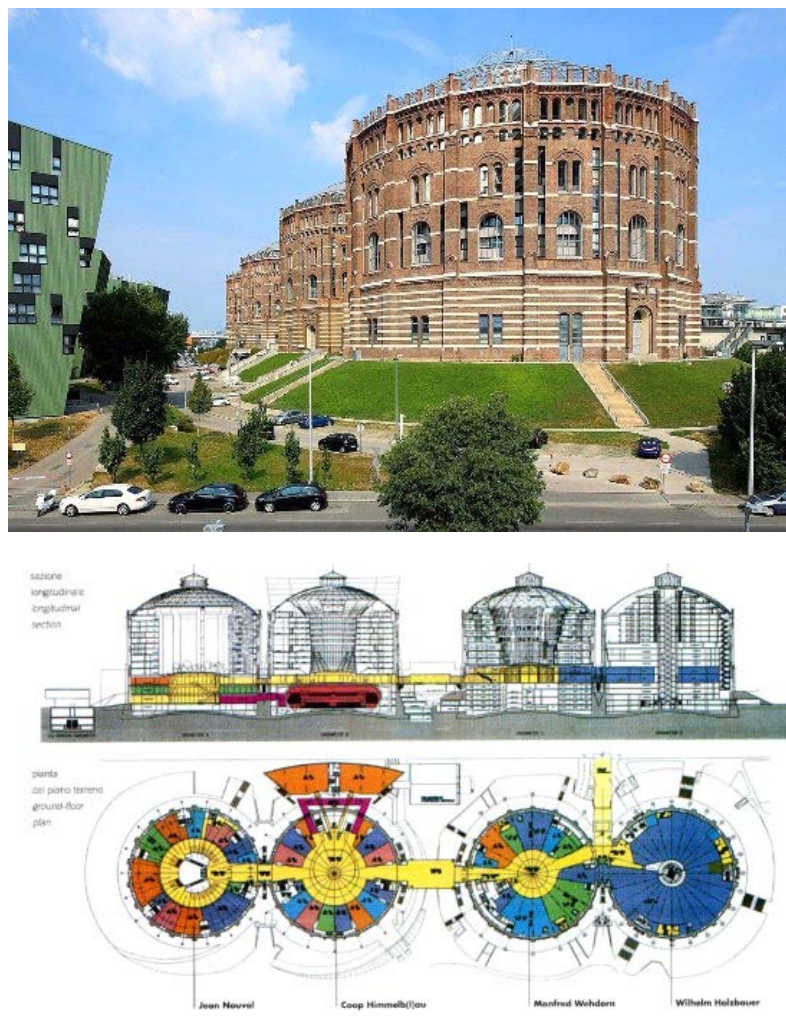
Реконструкция газометров в Вене, Австрия (фотография зданий, разрез с планами) [3]
